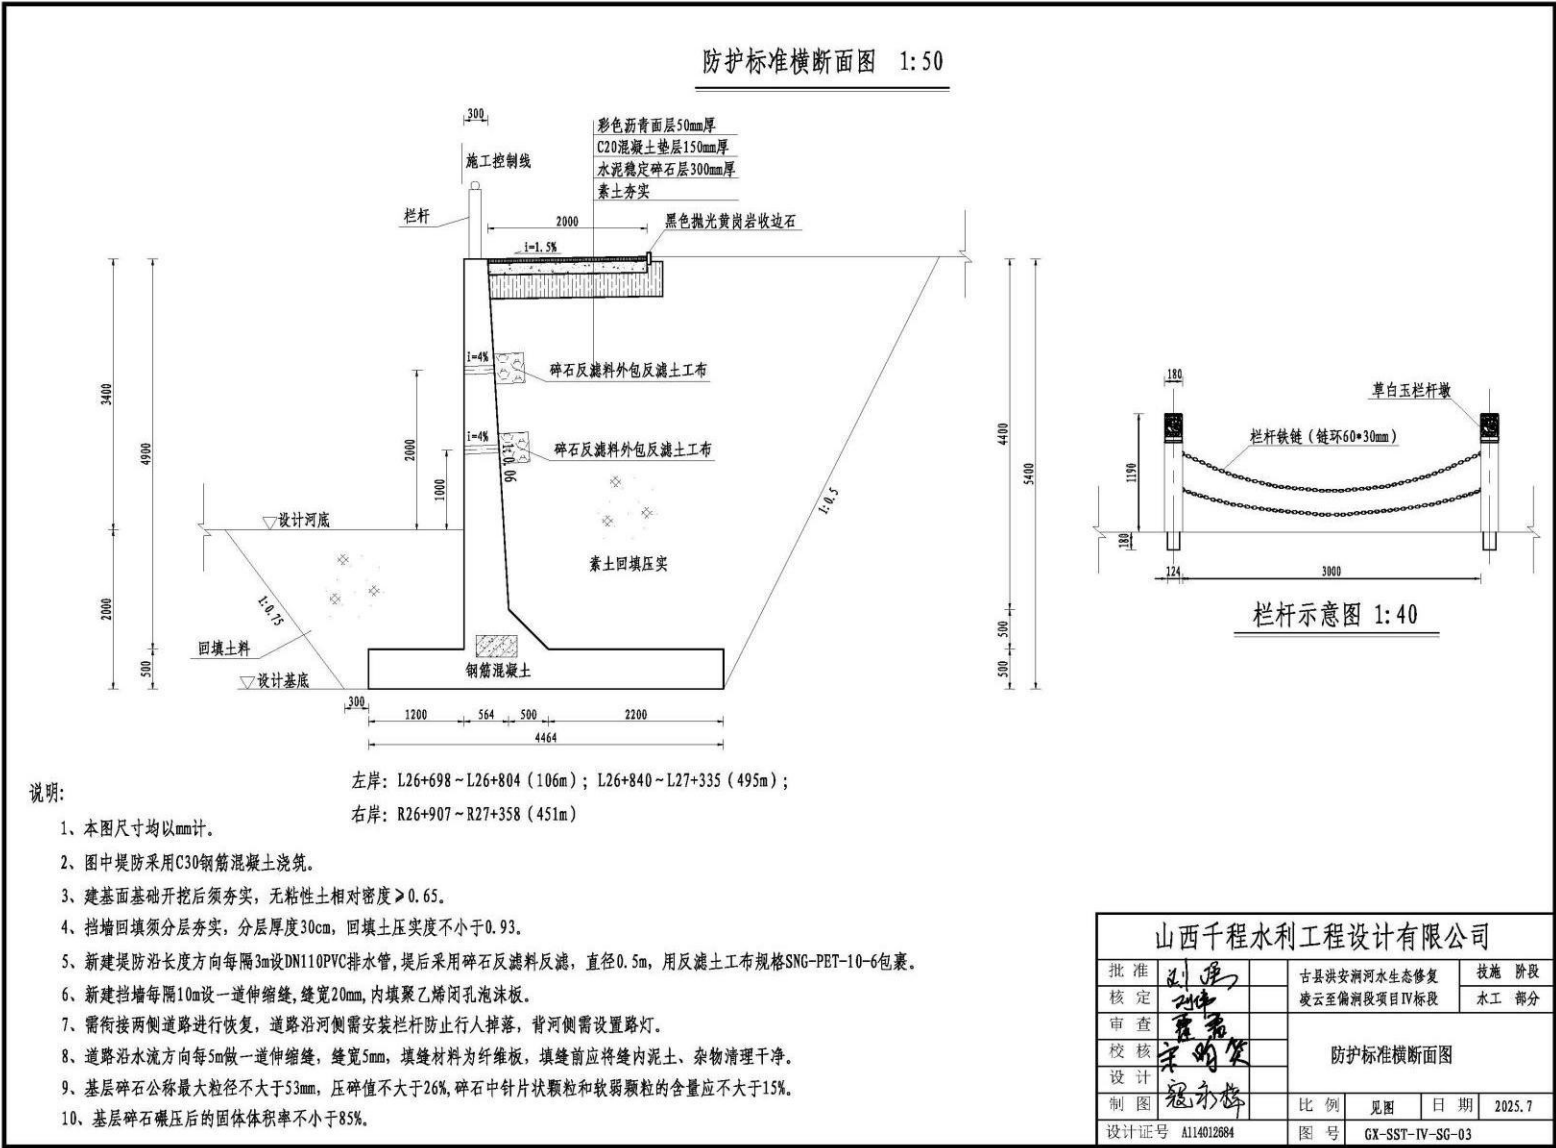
钢筋混凝土悬臂式堤防横断面图
